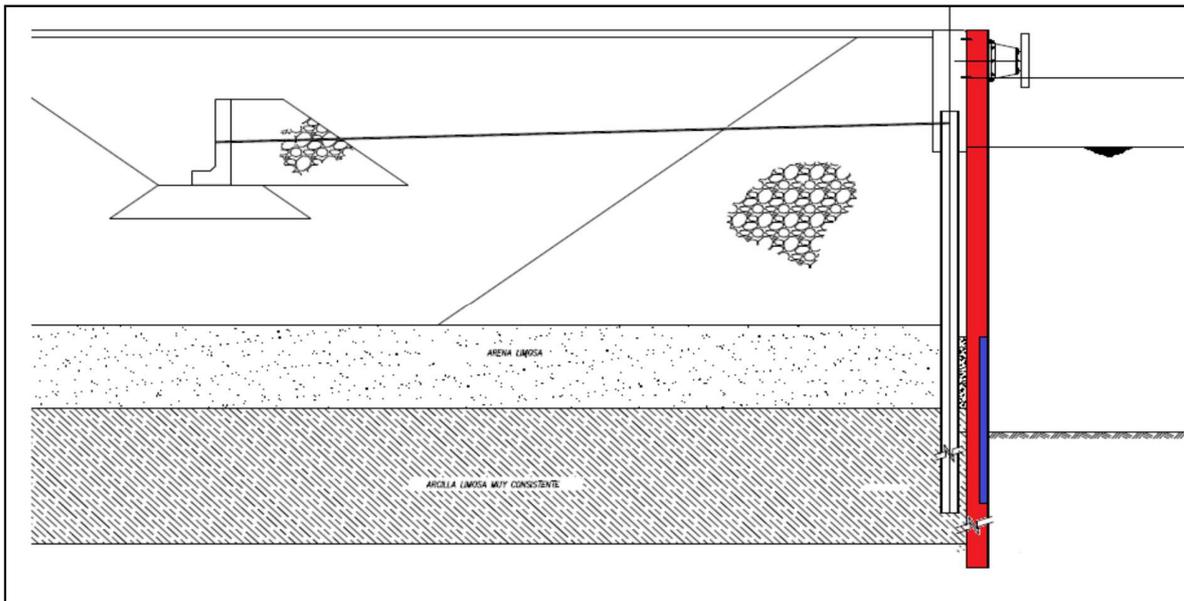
Esquema Estructura Adicional Sitio 4 sección transversal
